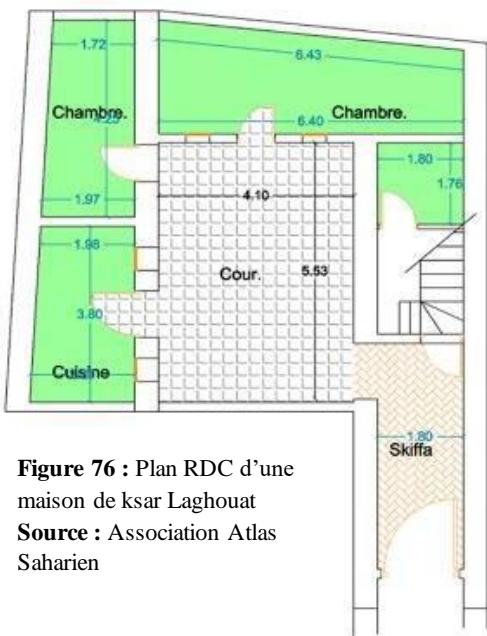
Plan RDC d'une maison de ksar Laghouat
